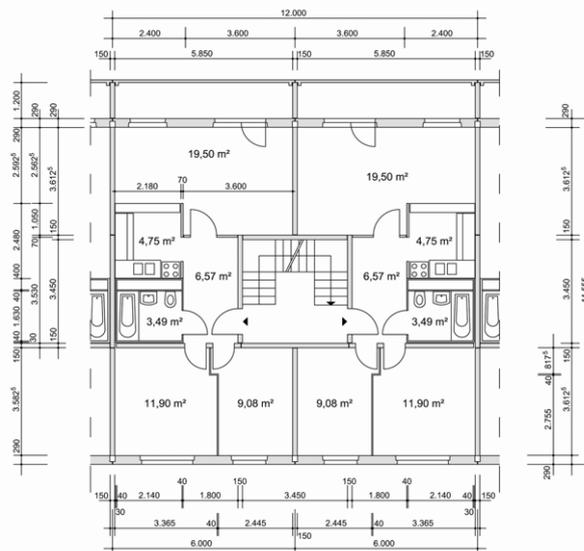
Grundriss eines Normalgeschosses – Segment der Bauserie P2, Mettke [6]
